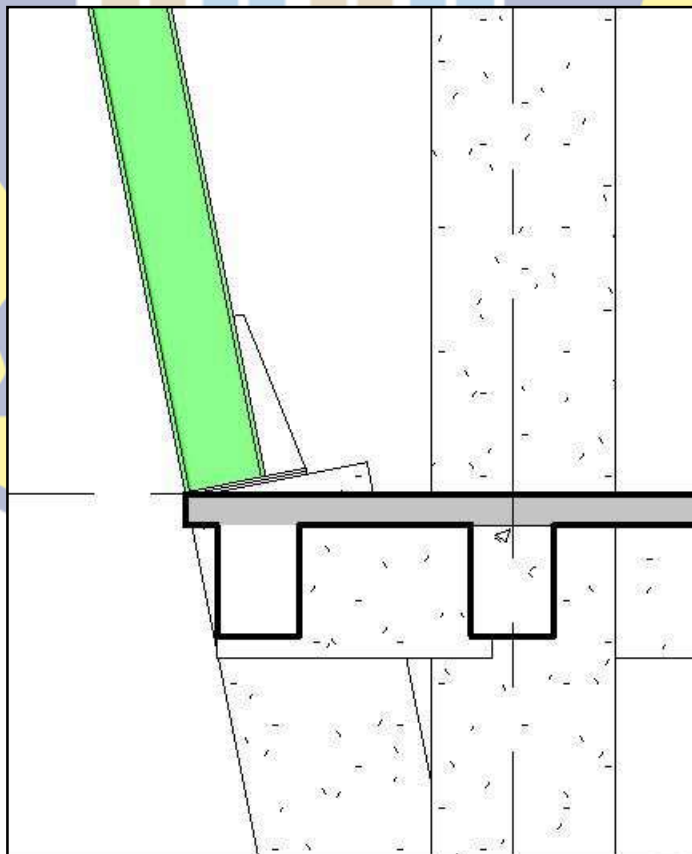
Denah gambar *for construction* kolom miring gedung P1 & P2
